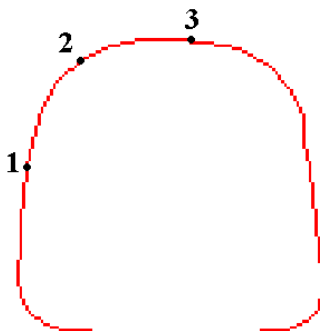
Схема модели горной выработки. 1-3 опасные участки выработки, соответственно стенка, угол, кровля.
